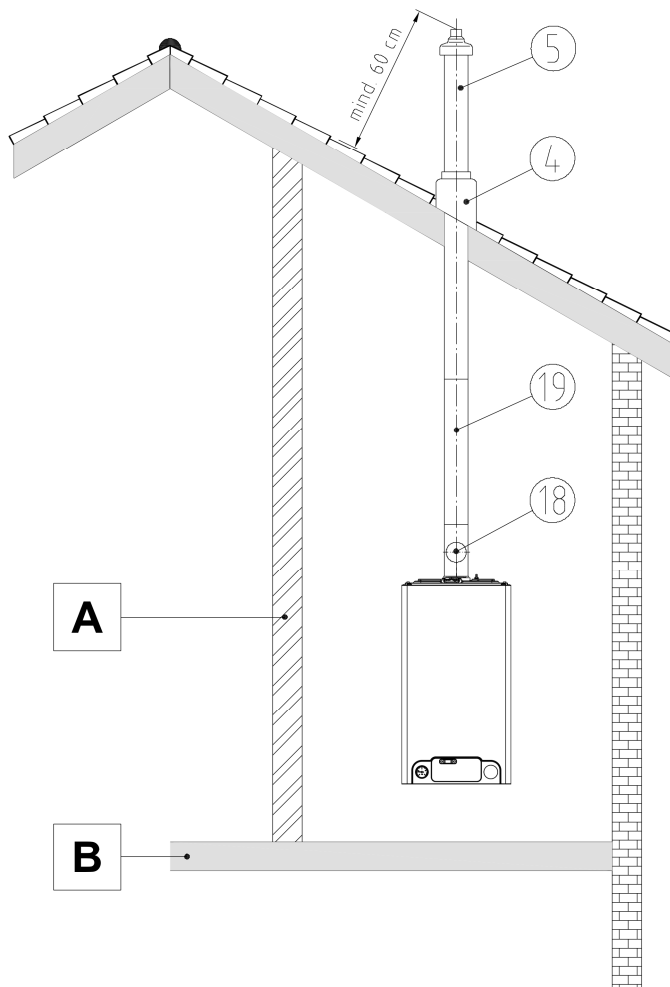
C₃₃X Raumlufunabhängiger Betrieb, Dachheizzentrale mit der Durchführung senkrecht durch ein Schrägdach
